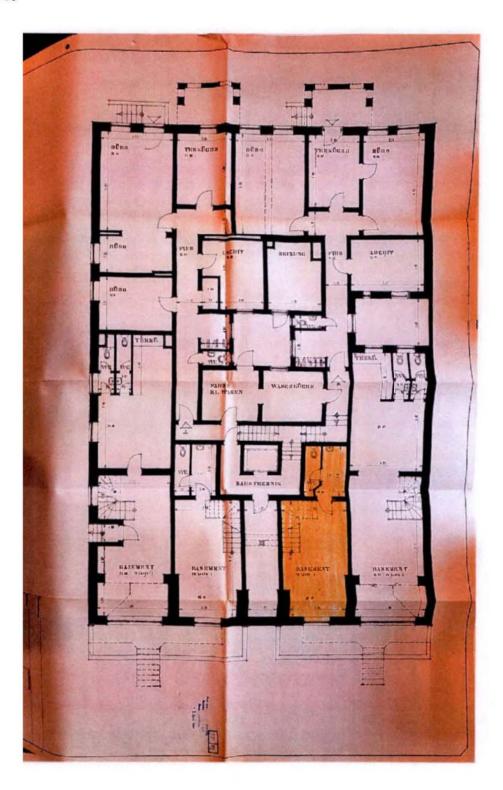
Altplan Bestand Grundriss Untergeschoss
